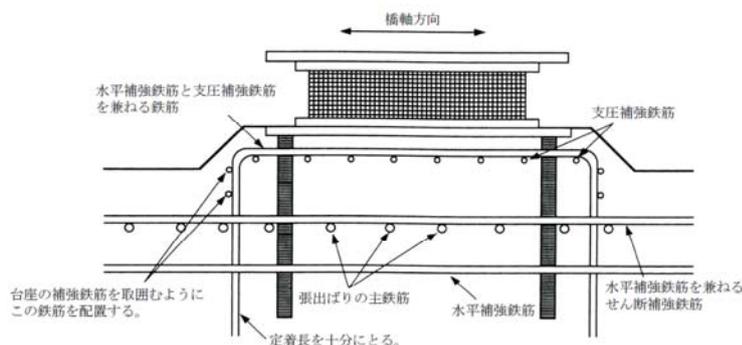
沓座がある場合の橋座部の配筋例（道示IV編, 図-解 7.6.8）
